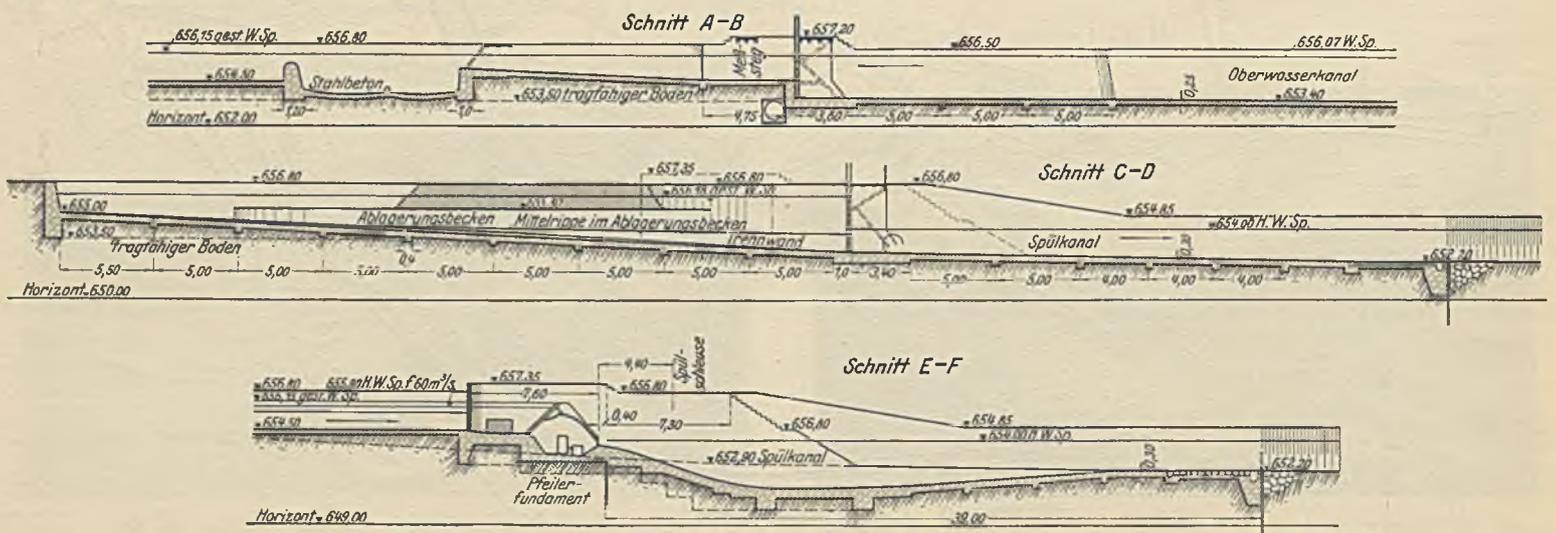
Wehr und Einlaufbauwerk im Schlierachtal.
